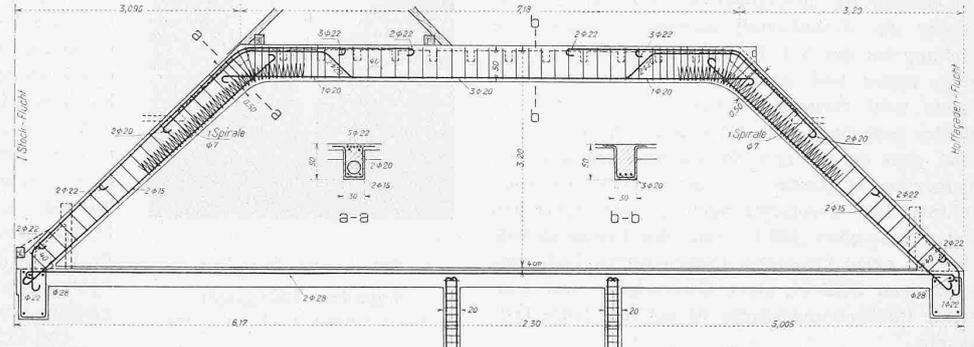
Querkräfte und Momente. — Dachbinder B des Palace-Hotel Bellevue in Bern. — Abb. 16. Armierungsplan 1 : 100.
